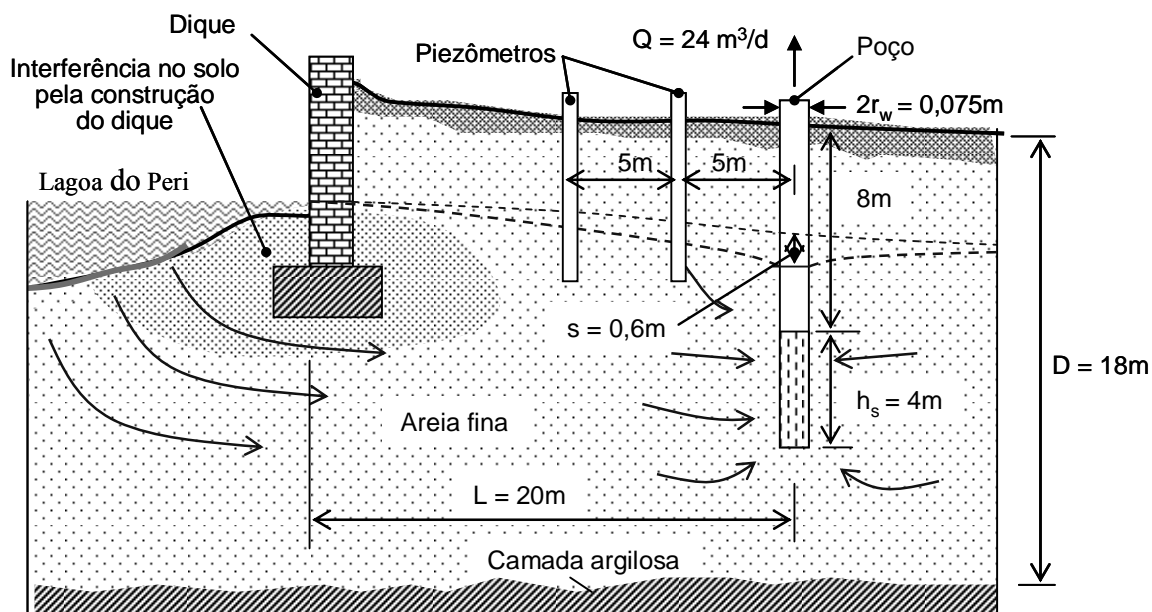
Corte esquemático do sistema piloto de filtração em margem na lagoa do Peri. (Sens et al. 2006).
